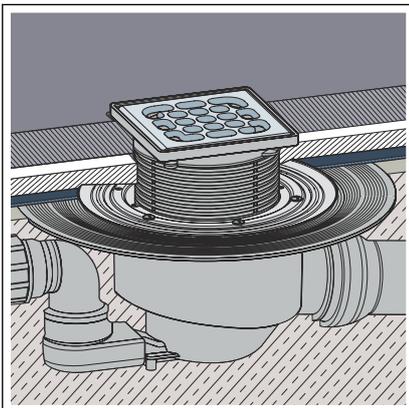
Allgemeines Montagebeispiel – Deckenaussparung
